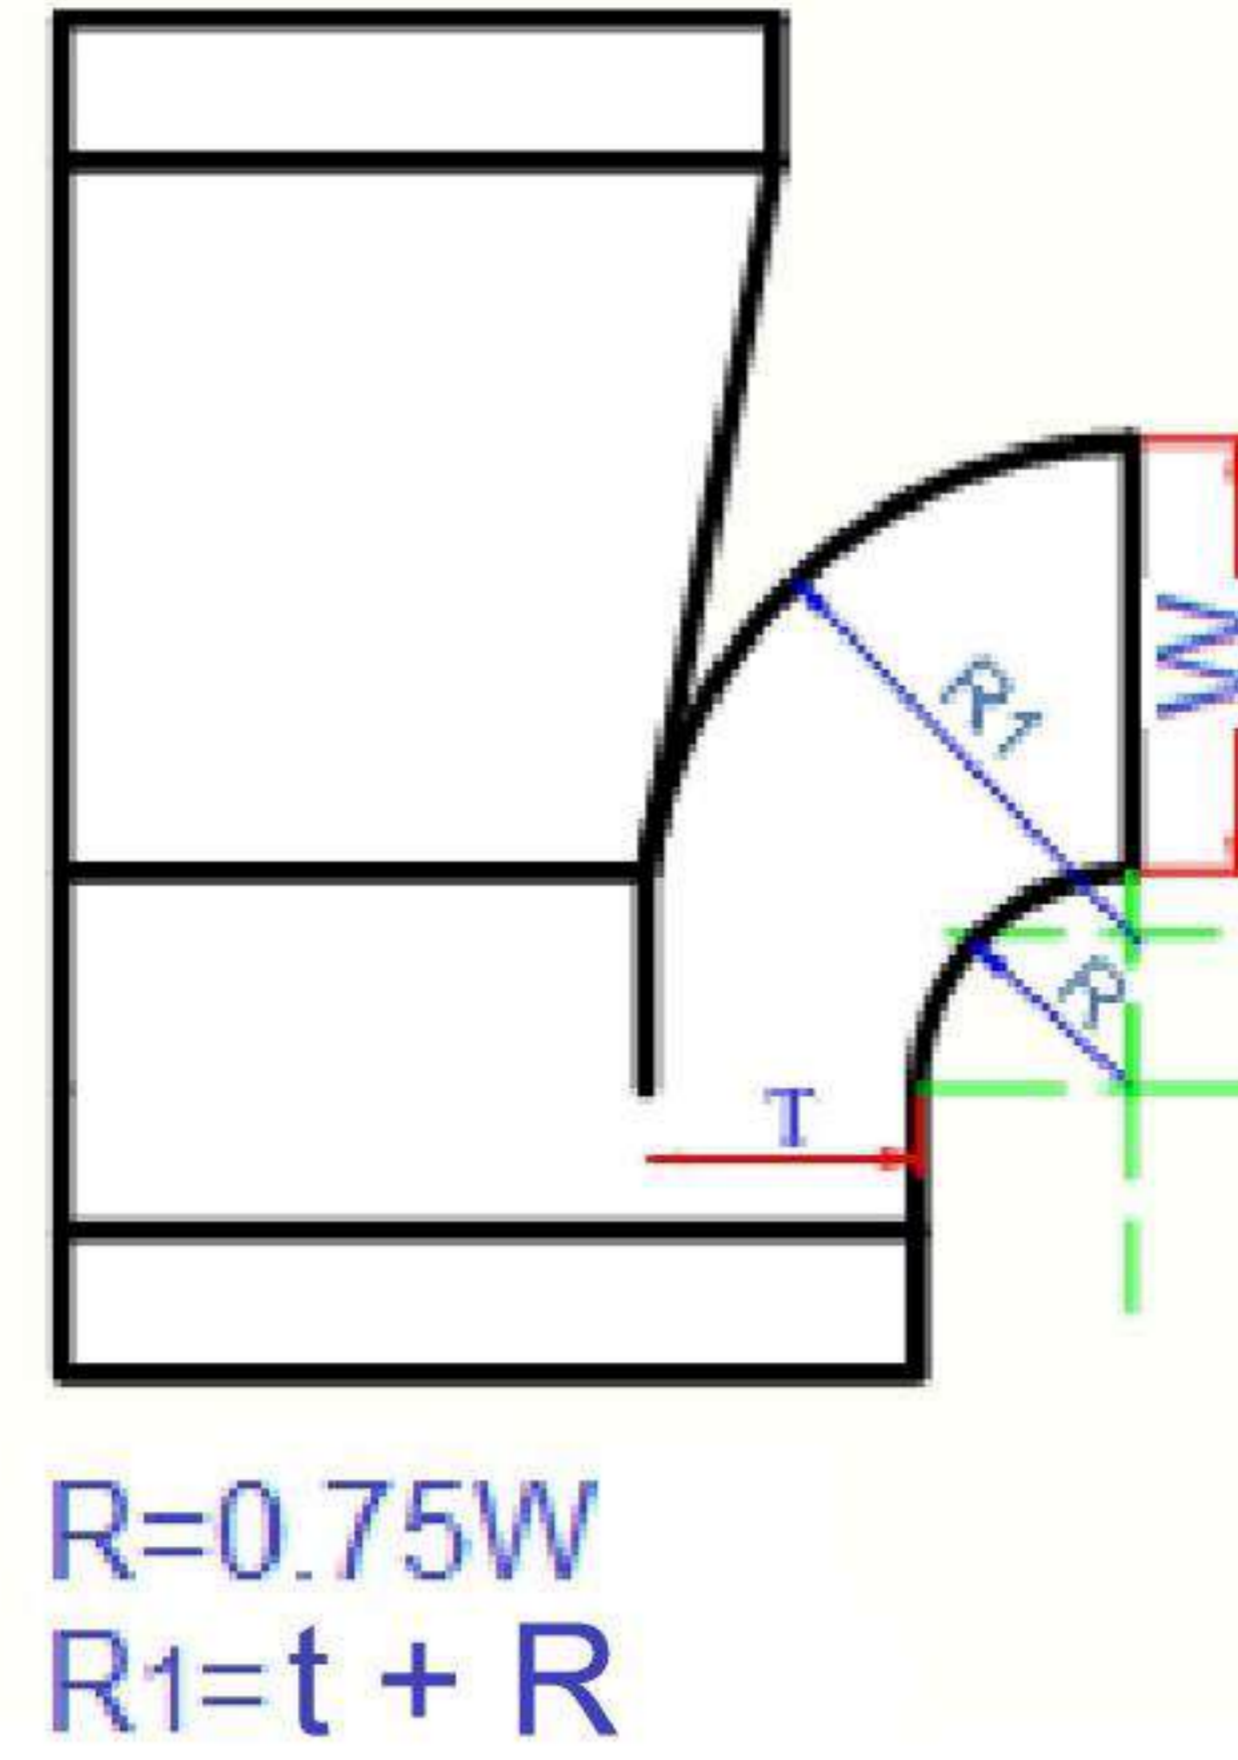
المسقط الأفقي مع مقطع أمامي لمجرى هواء بخطين مع مأخذ هواء مثالي ضمن بناية
